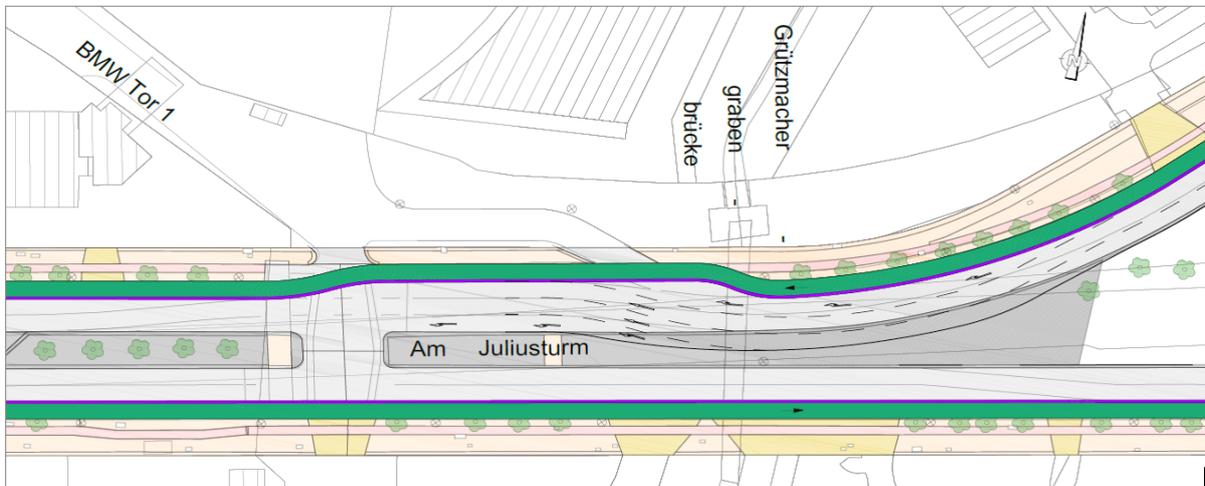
Am Juliusturm/Zufahrt BMW-Werk – Ausschnitt Lageplan
